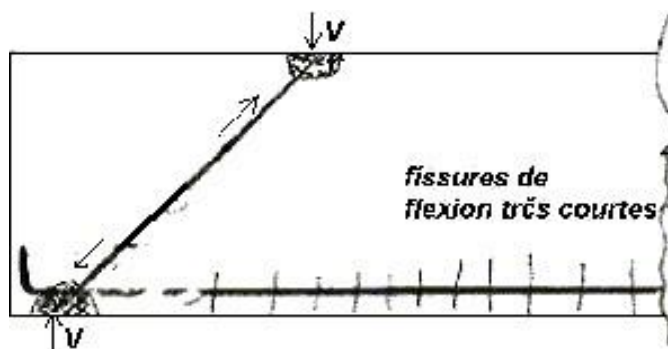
Etat de fissuration à la rupture d'une poutre avec  $(a/d \leq 1)$  [10]
